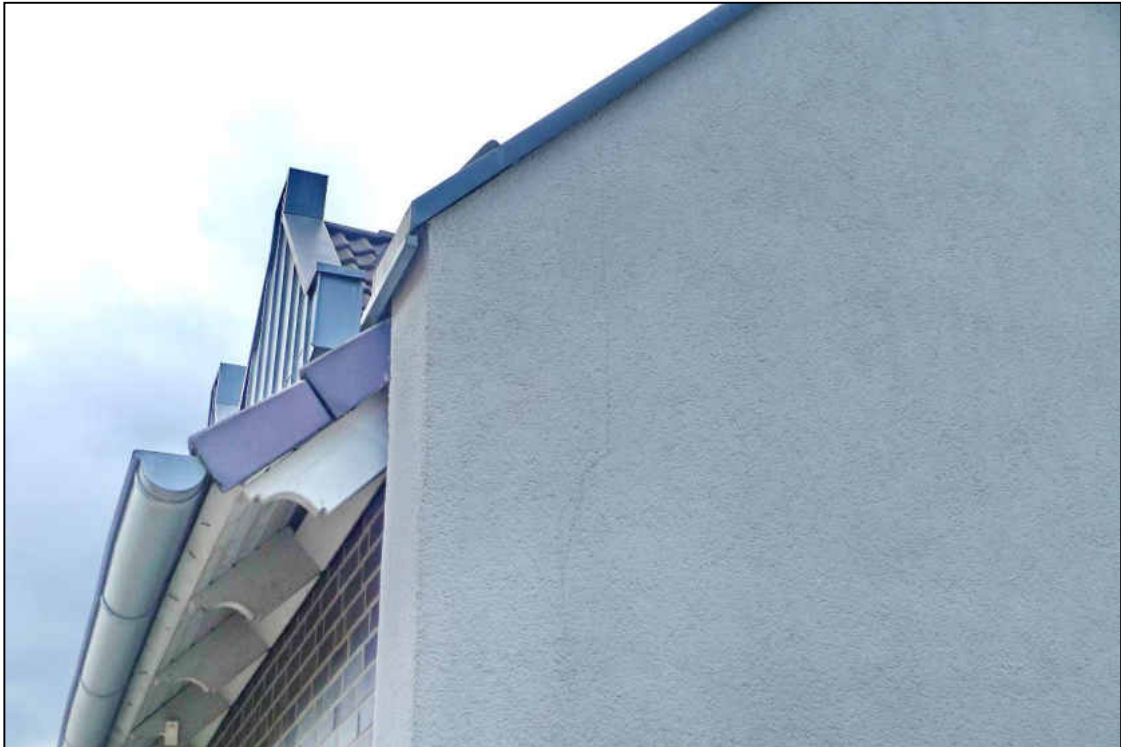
Rissbildung an der Ostseite der Fassade
